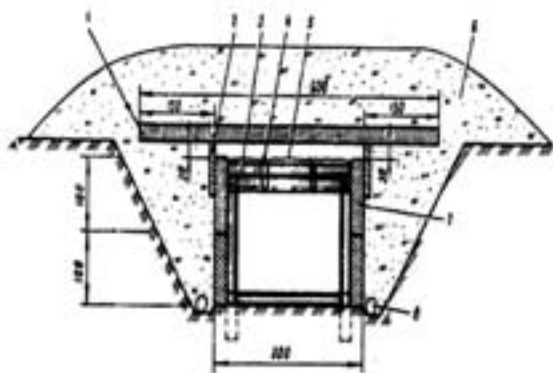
Швидкоспоруджуване сховище податливої конструкції з панелей перекриттів: 1 – залізобетонна панель перекриття типу ПК; 2 – дерев'яний щит; 3 – дерев'яна розпірня рама; 4 – дротова скрутка; 5 – гідроізоляція; 6 – насипний ґрунт; 7 – стінова плита типу ПК; 8 – дренаж.
